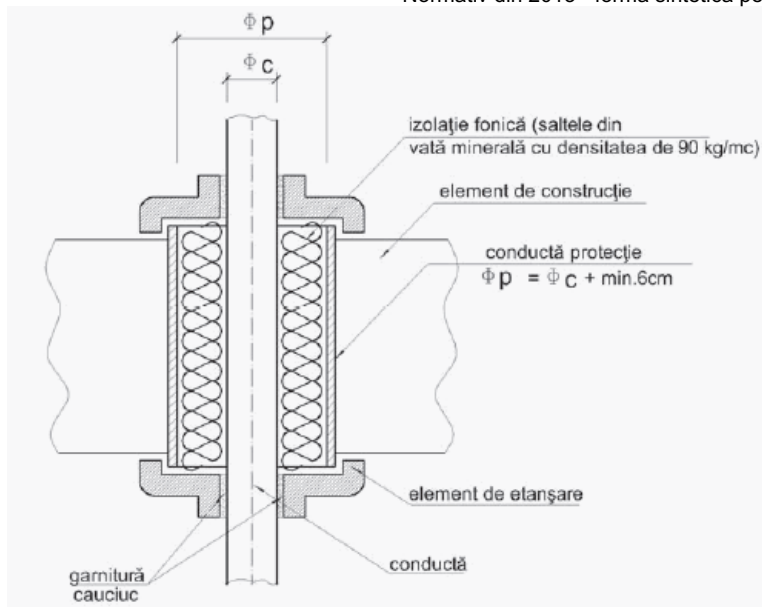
Izolarea fonică a conductelor la trecerea prin elementele de construcție
